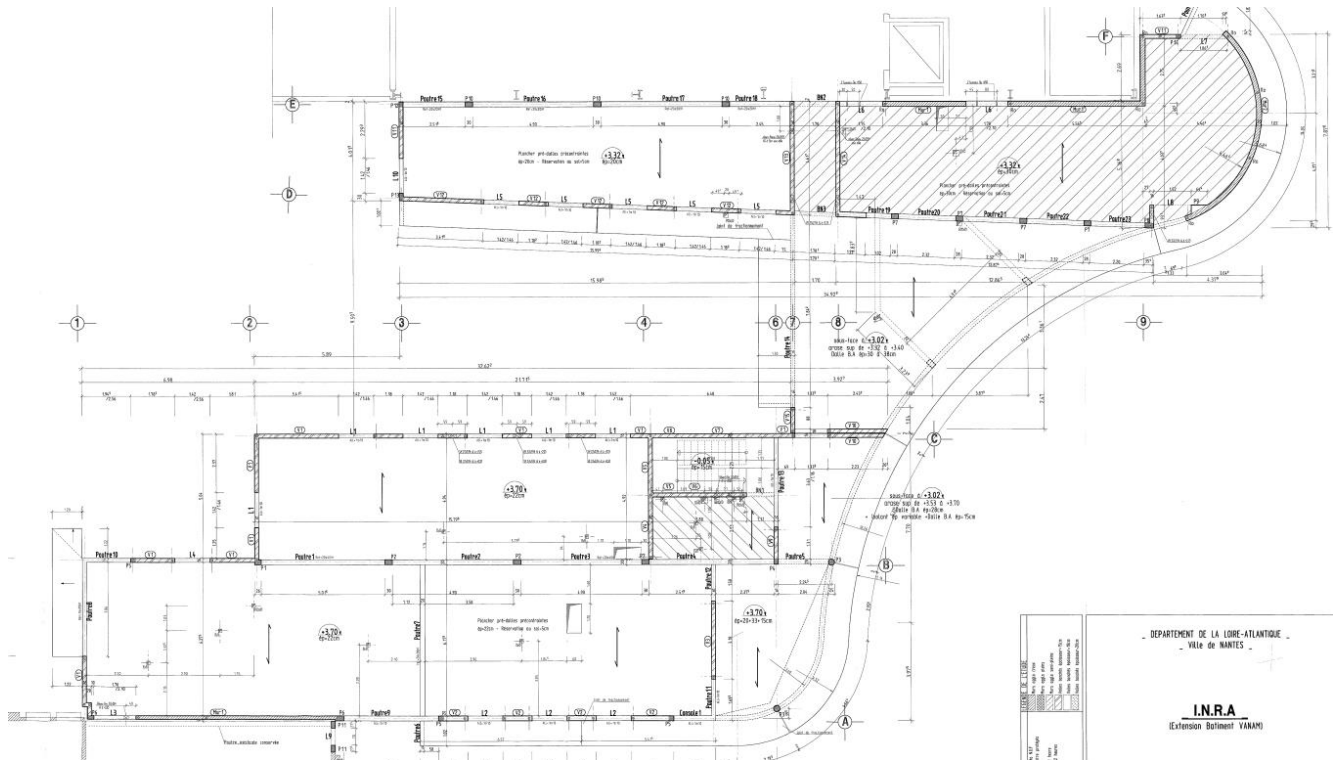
Extrait Coffrage niveau RDC / Plan SERBA 96.158 – EXE11C
